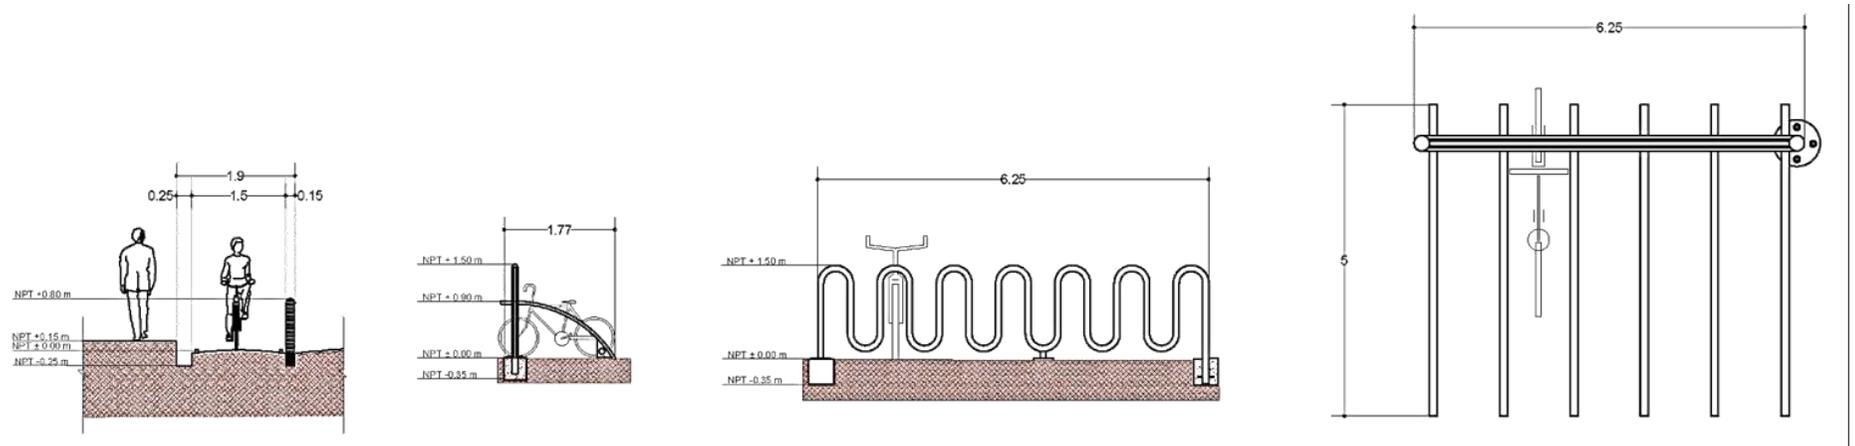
Detalles en alzado de la ciclopista y estacionamientos para bicicletas
